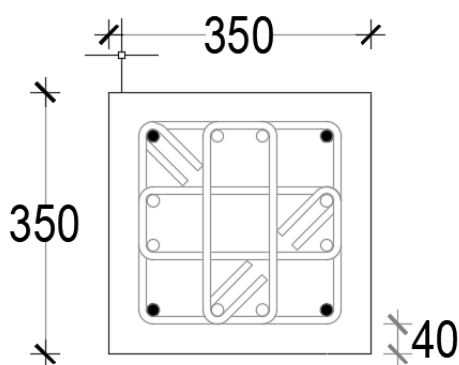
Armado de columnas #12 y #14 de entepiso y cubierta
